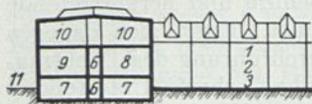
Dreischiffige Werkstatthalle mit zwei Galeriegeschossen in den Seitenschiffen.
